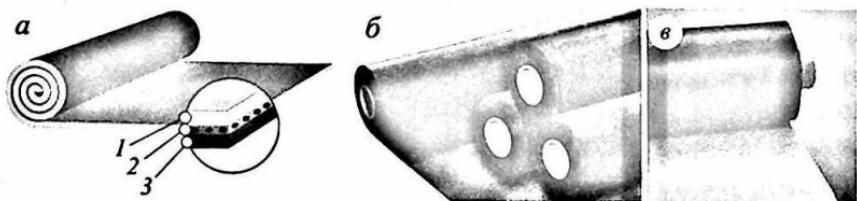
Виды гидроизоляционных мембран на полимерной основе:
